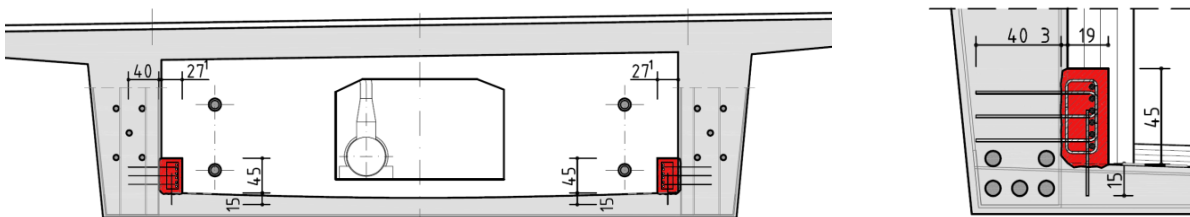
Stahlbetonbalken mit Betonstahlbewehrung im Querschnitt (links) und im Detail (rechts)
